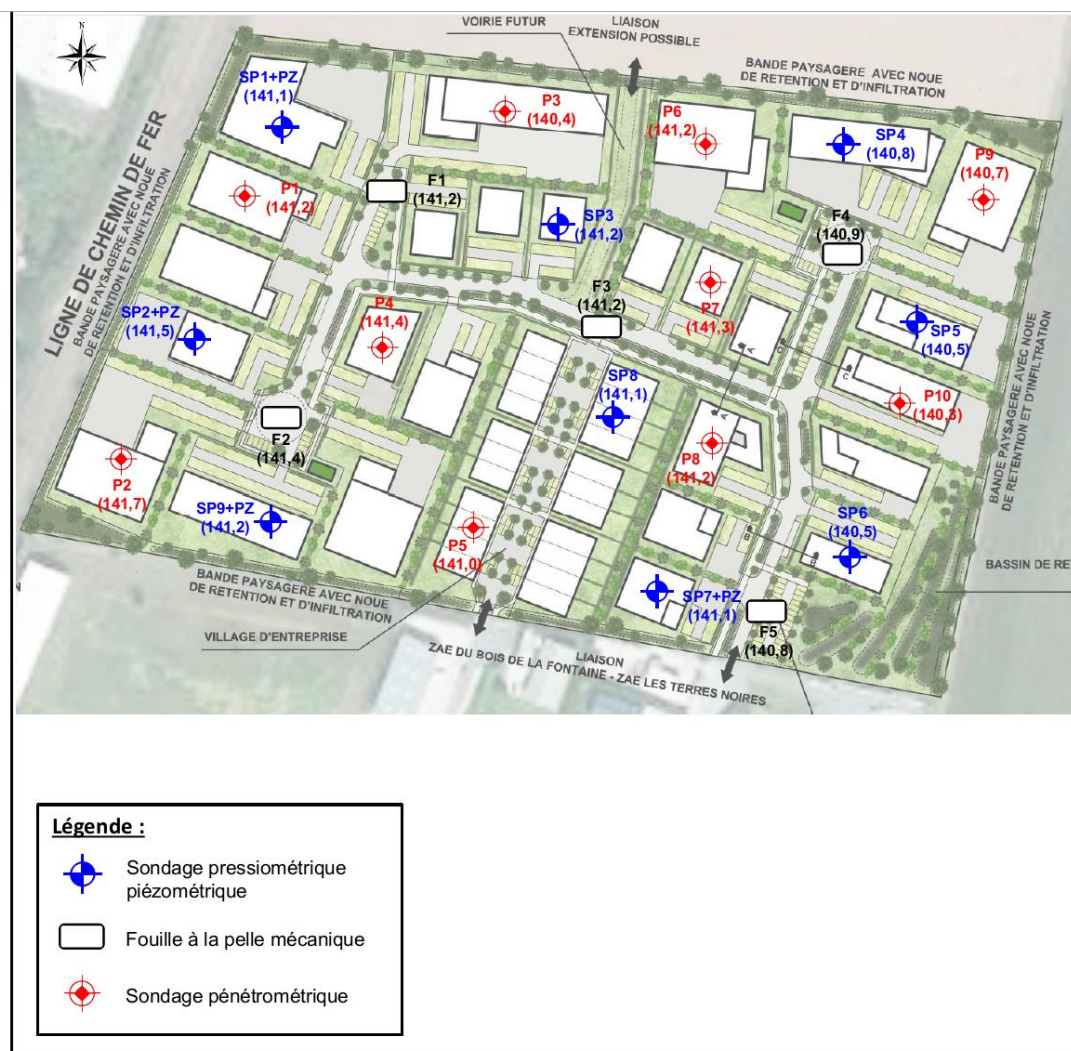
Plan d'implantation des sondages ( source: Atlas géotechnique)
